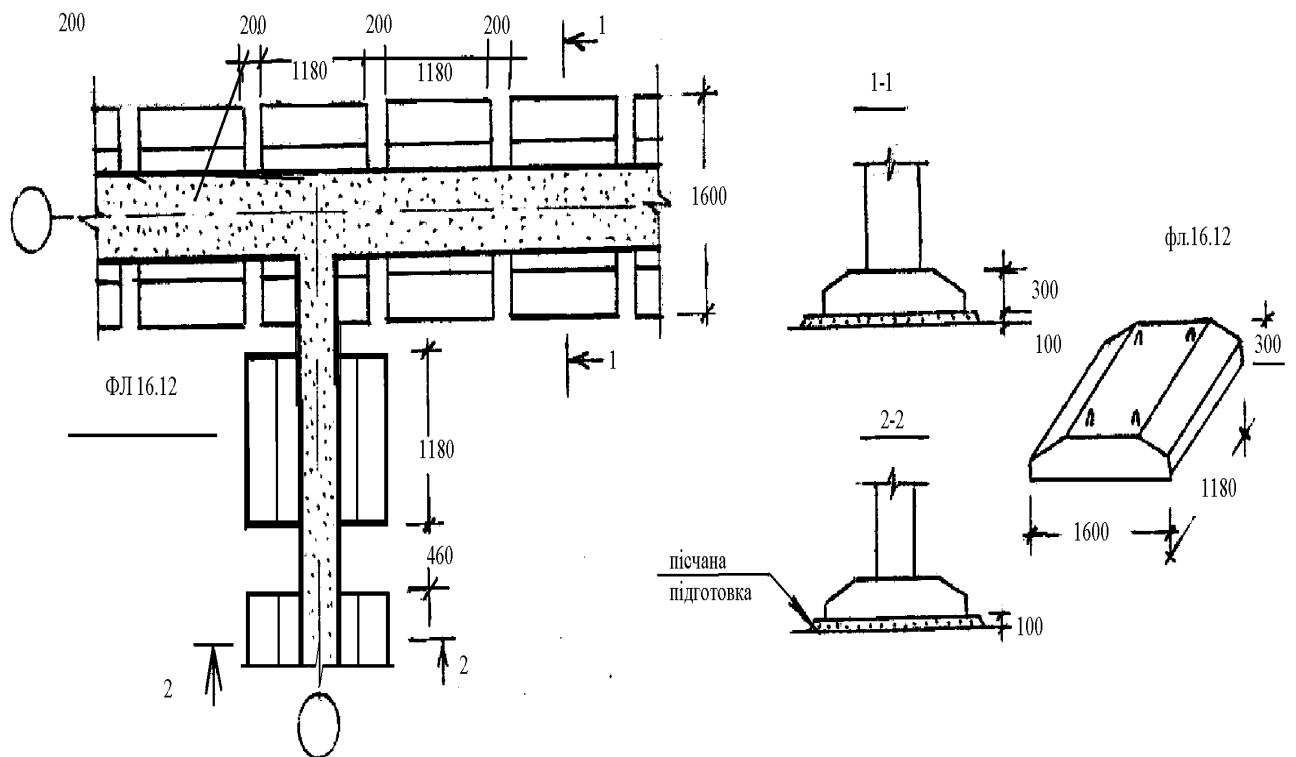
Фрагмент плану фундаментів і стін підвалу (цоколю) до прикладу 5.1
